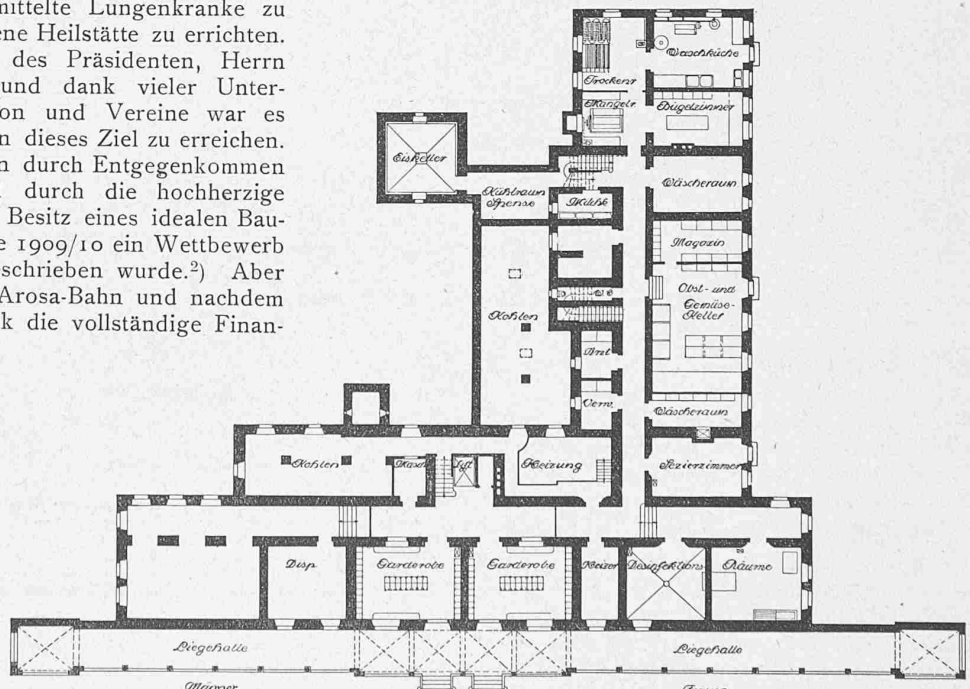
Grundriss vom Untergeschoss. — Masstab 1:500.
